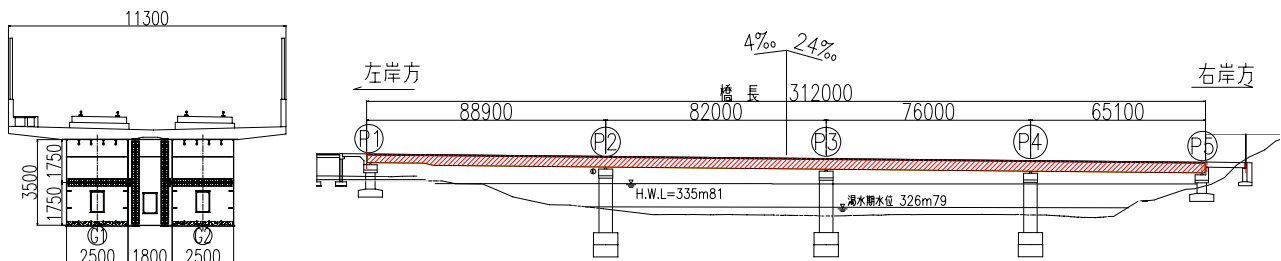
第4千曲川橋りょう標準断面図(左)および側面図(右)
